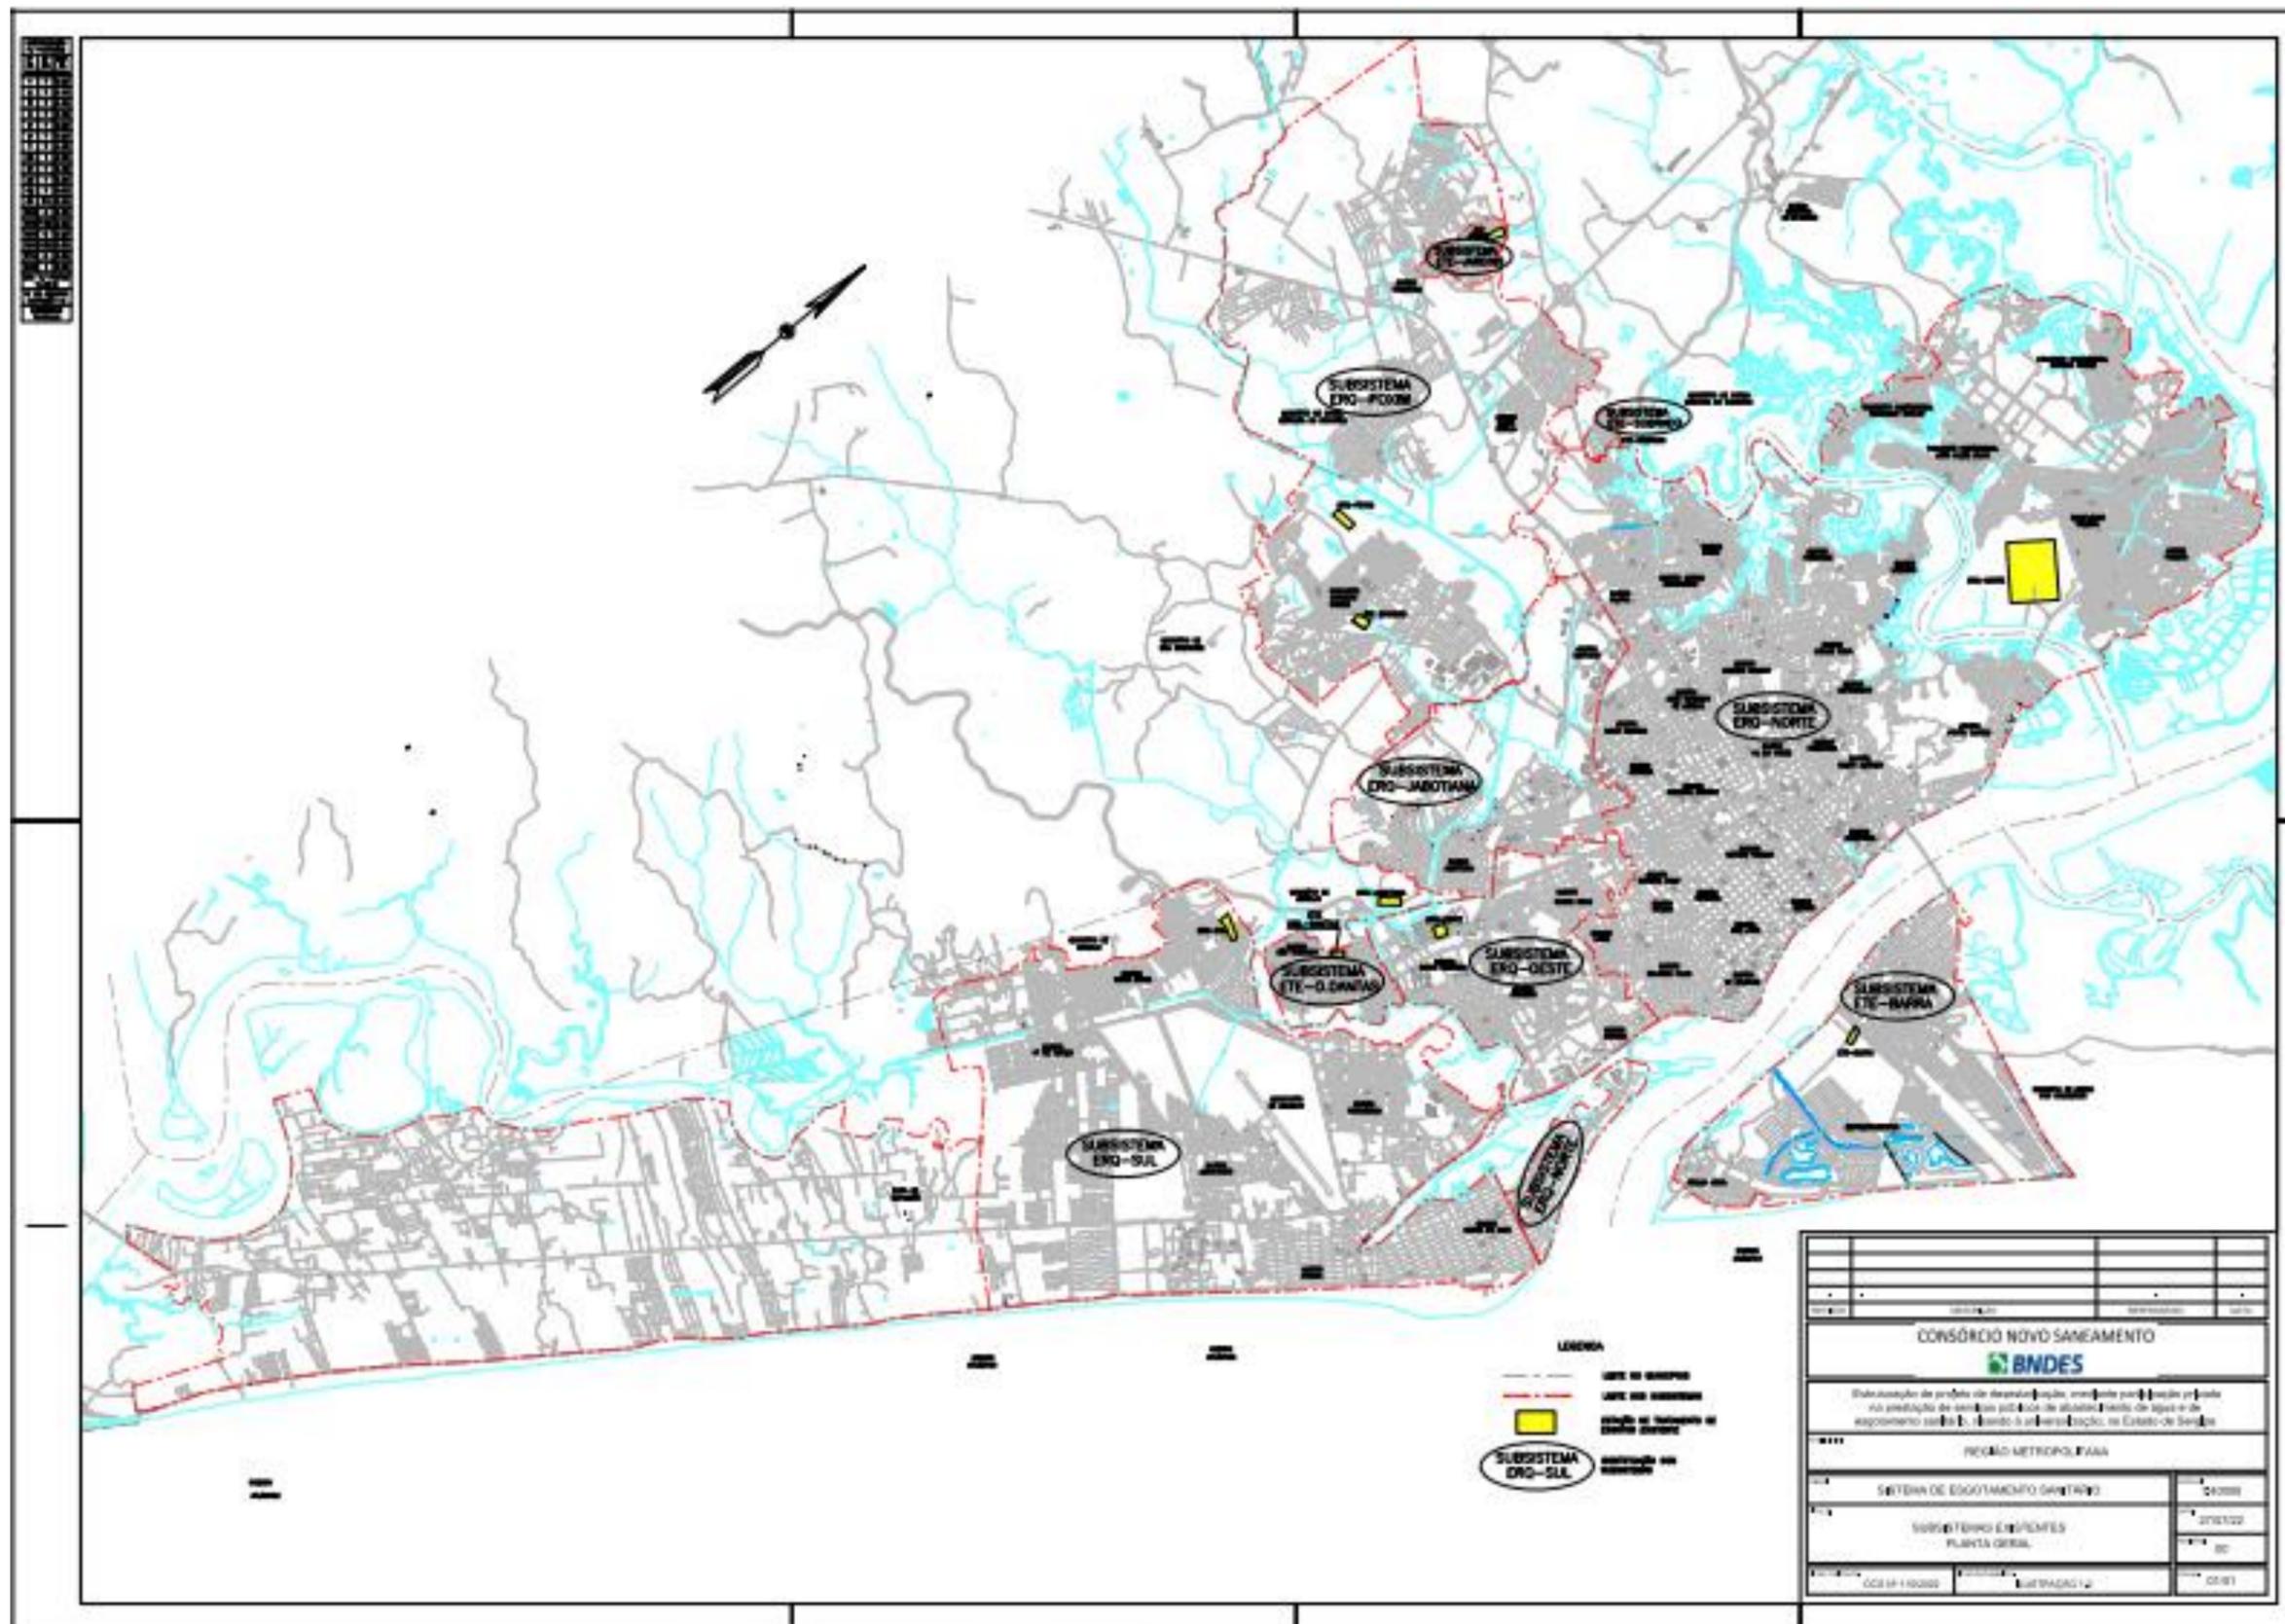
Planta Geral do Sistema de Esgotamento Sanitário da Região Metropolitana
